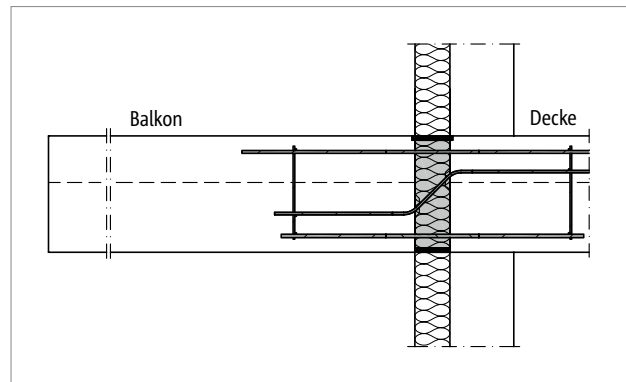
Schöck Isokorb® XT Typ BP: Balkonkonstruktion mit frei auskragenden Unterzügen
